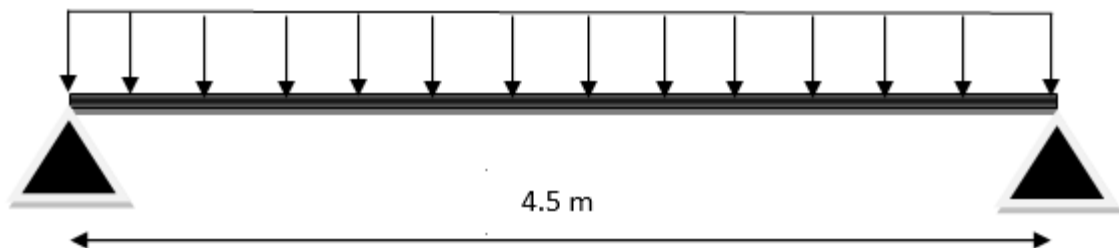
Schéma statique de la poutre secondaire (terrasse).
